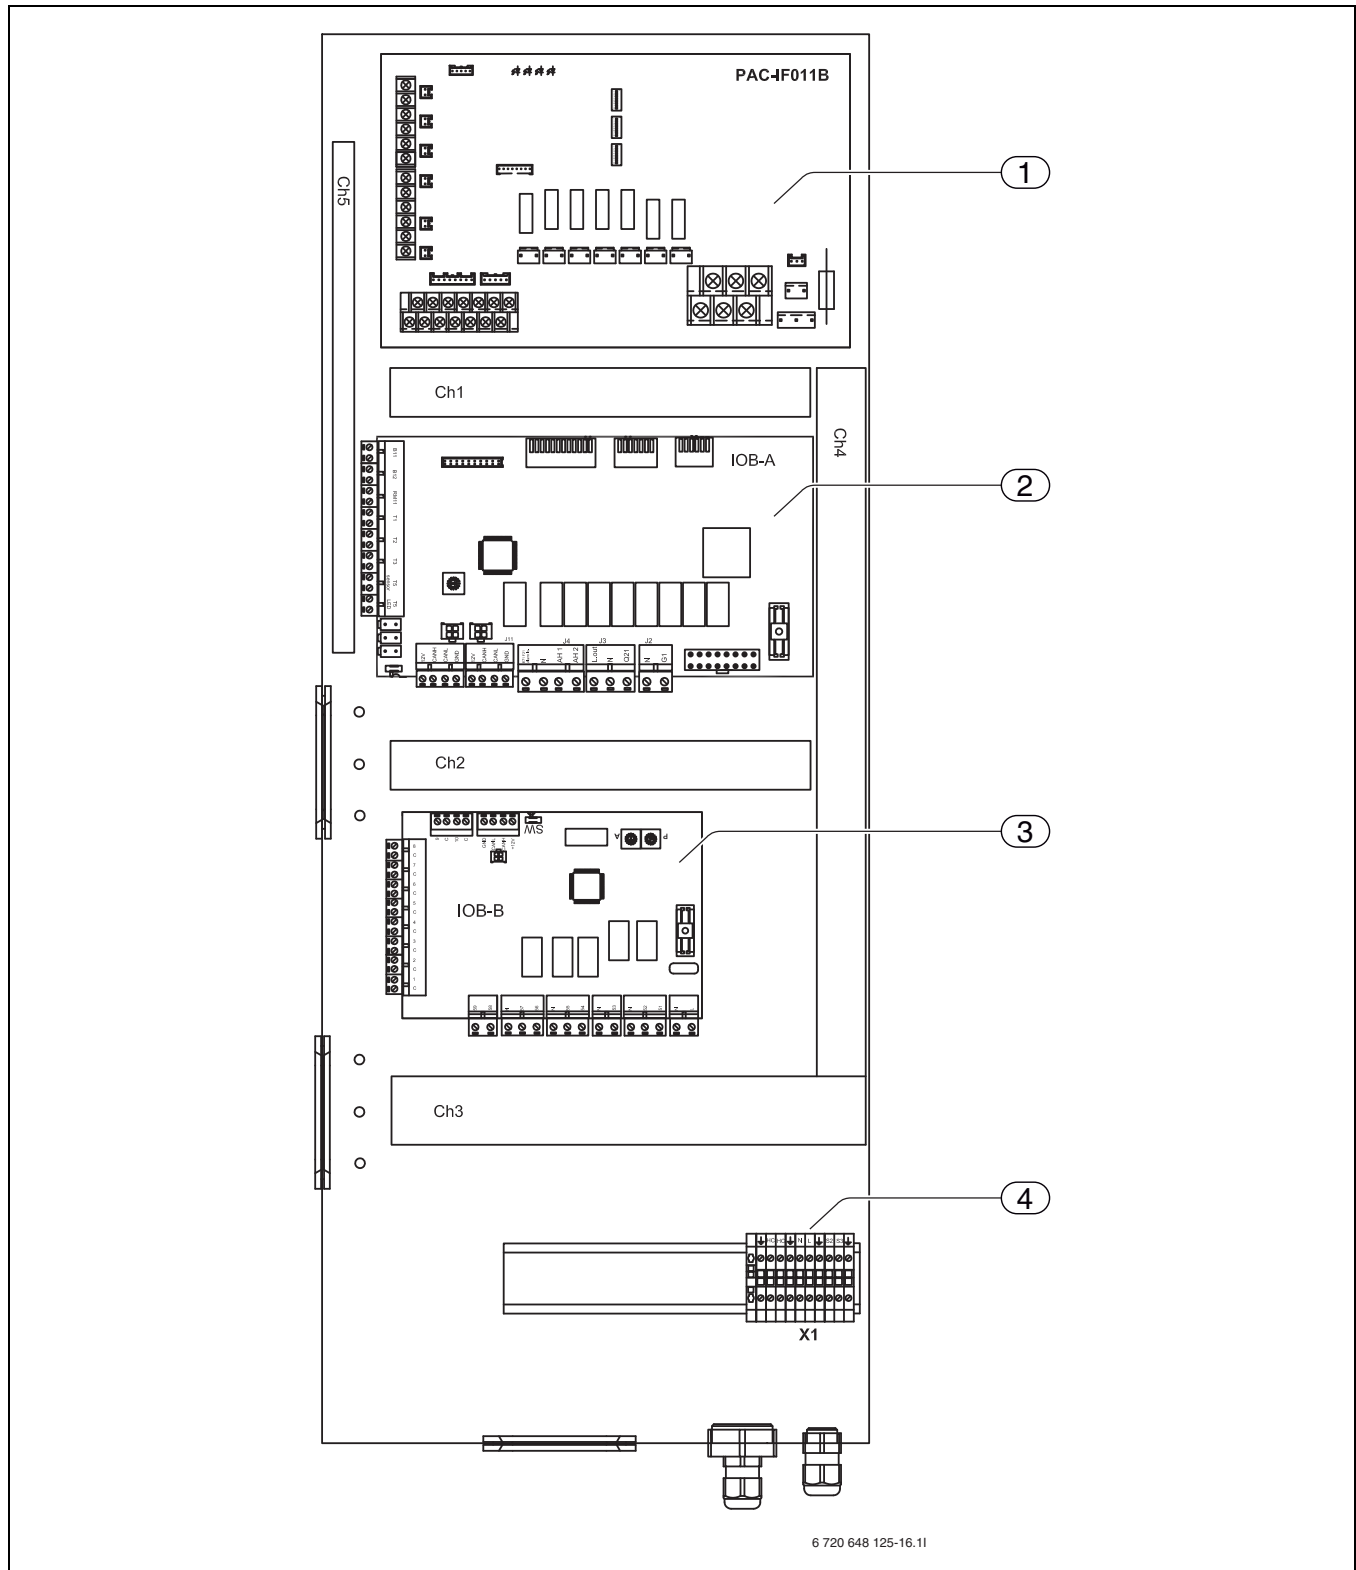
Layout im Schaltschrank, WPLS-Modul und 2. Wärmeerzeuger
